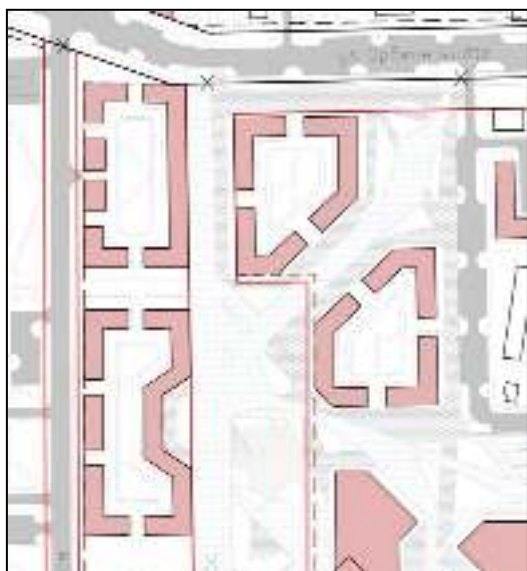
Фрагмент генплана. Формирование новых кварталов
